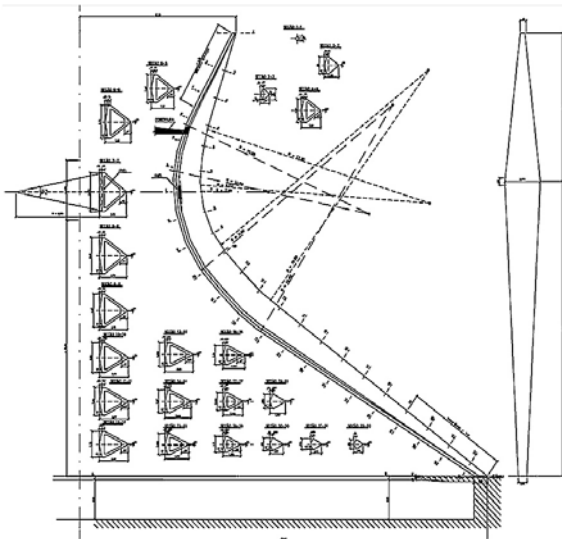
Sistema estrutural da Catedral – Anel de tração, estrutura em grelha, pilares, anel de compressão e laje de cobertura.
